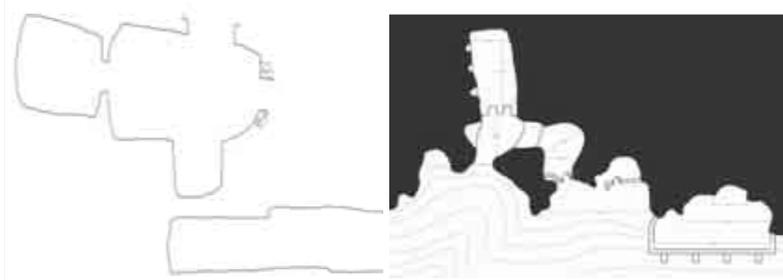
Planta y sección de la Cueva de la Paja. Artenara. (Varios Autores 2008)
